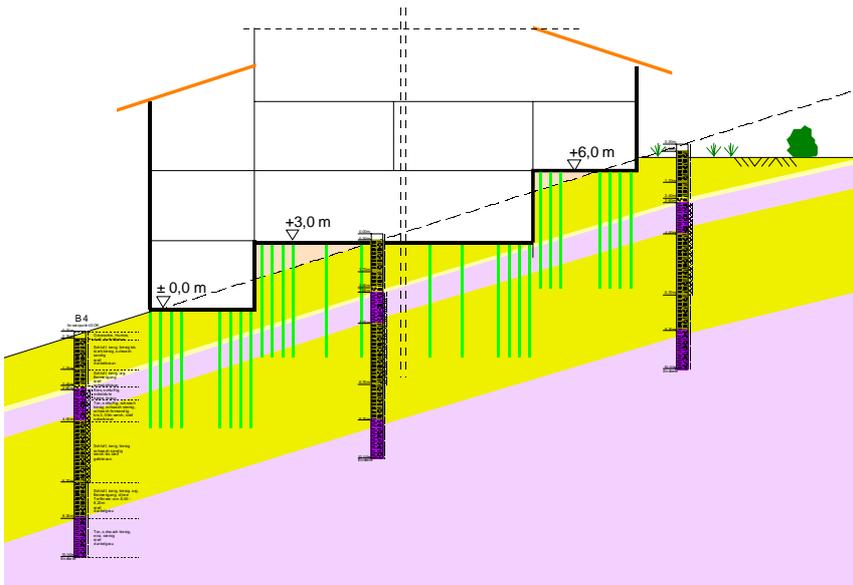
Stabilisierungssäulen als schwimmende Gründung
